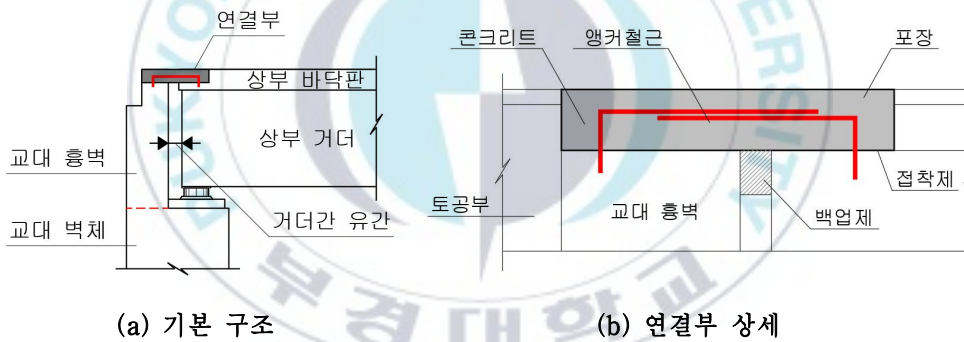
완전일체식 교대 교량(full-integral abutment bridge)
